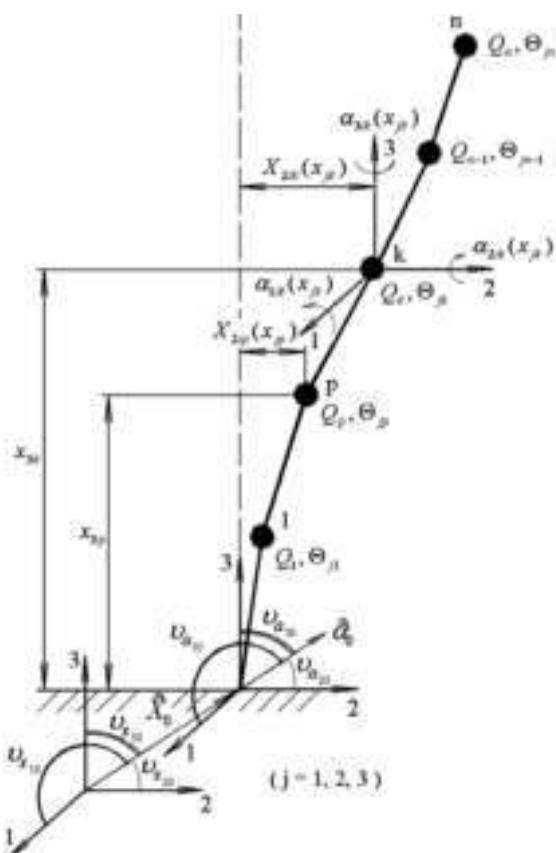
Спрощена розрахункова схема у вигляді невагомої вертикальної багатоповерхової консолі
